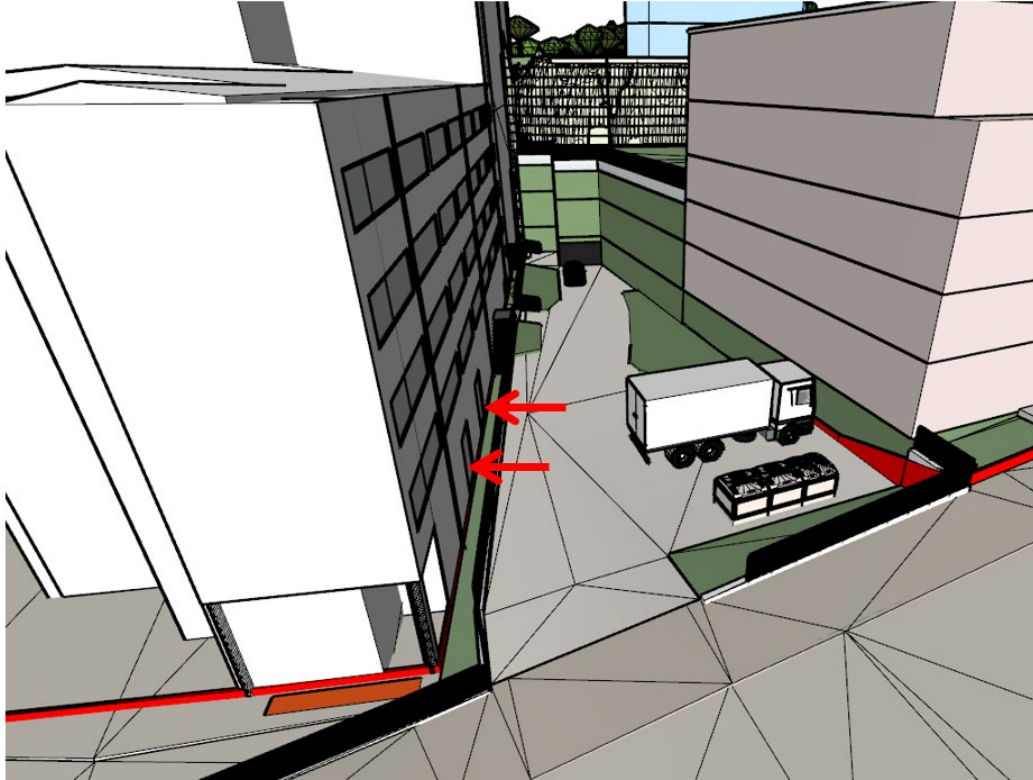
Utdrag ur 3Dmodell som visar föreslagen utrymningsväg, för kontorsbyggnaden och dess skolverksamhet. Utrymningsvägen är belägen mellan kontorshusets västra fasad och den föreslagna, 3 meter höga stödmuren. Bebyggelsen är schematiskt redovisad. Bild: ÅWL, 2026.
